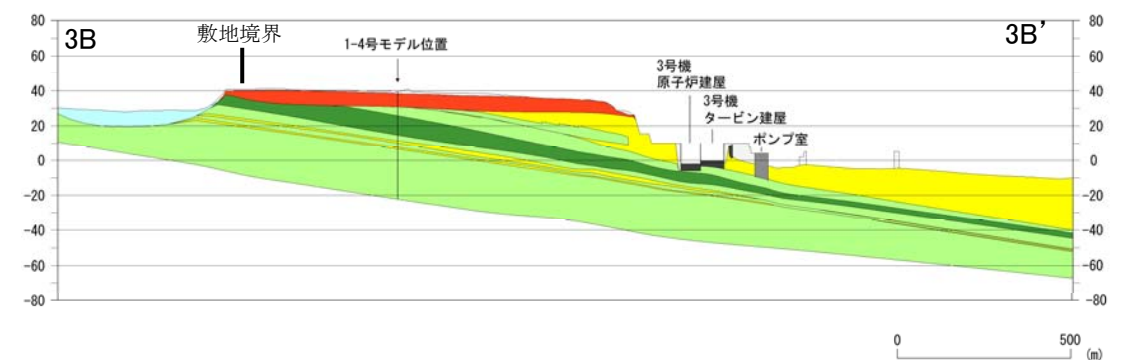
解析モデルの地質断面図 (3B-3B' 断面)
